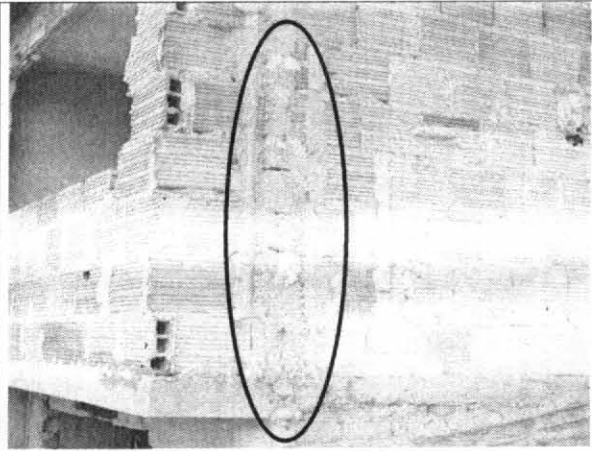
Elementos verticales mal fundidos, sin sección definida.
